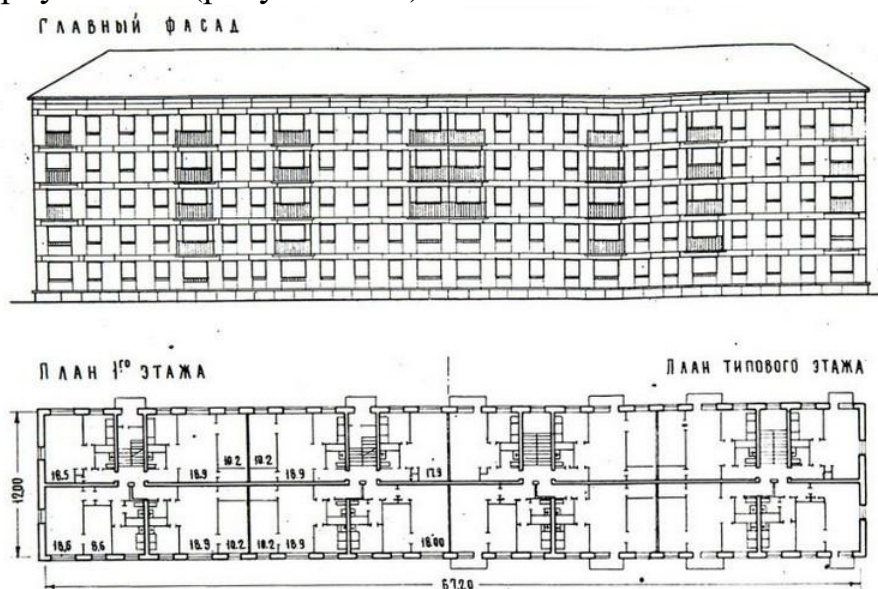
Жилой дом серии 1-439. Главный фасад и планы здания
